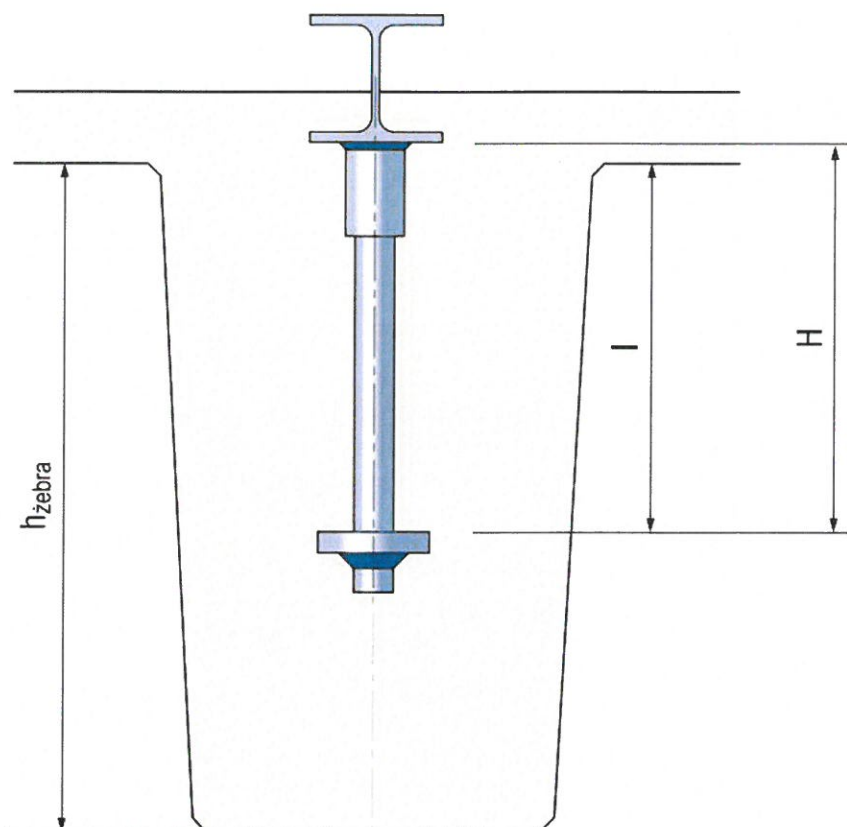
Typ 1 podparcia elementu żelbetowego z zastosowaniem podkładu stalowego PFEIFER PS-A (przypadek „wąskiego” elementu żelbetowego)
